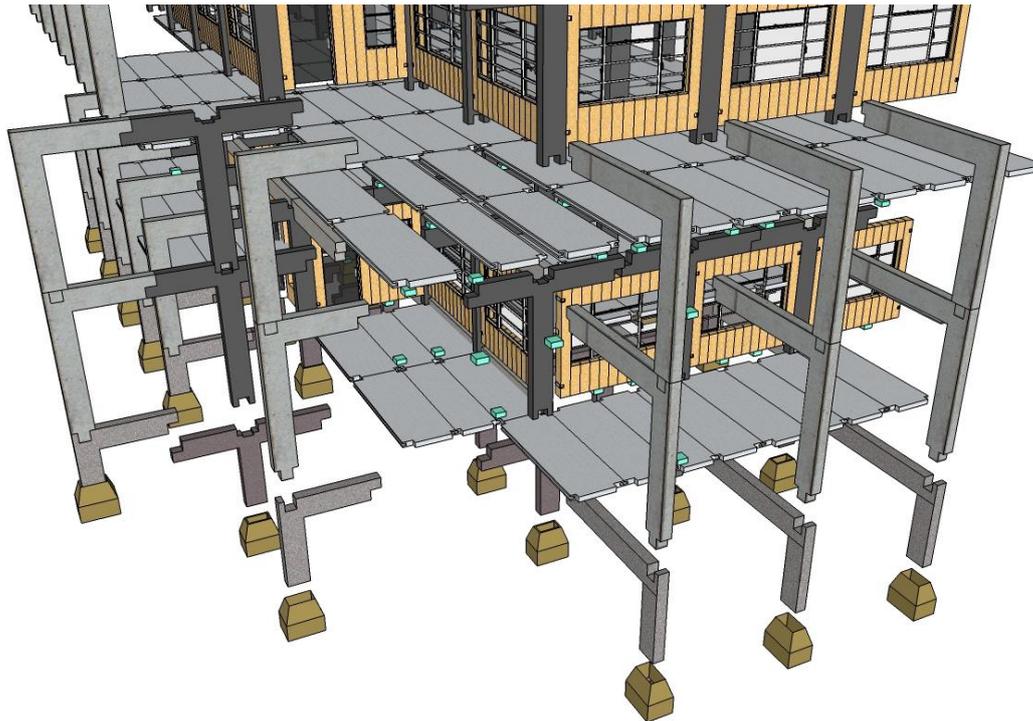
Exemple d'assemblage semelle , amorce, poteau, cloison et dalle en beton
